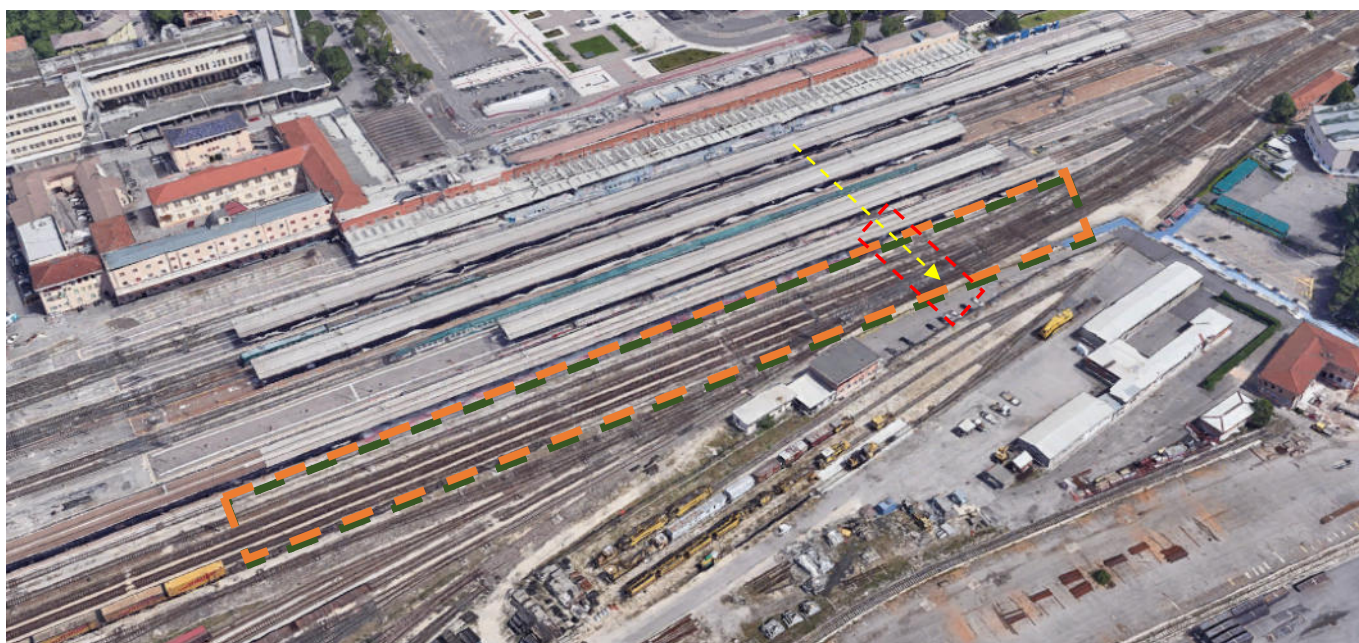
FV08 – Identificazione della posizione in vista 3D
